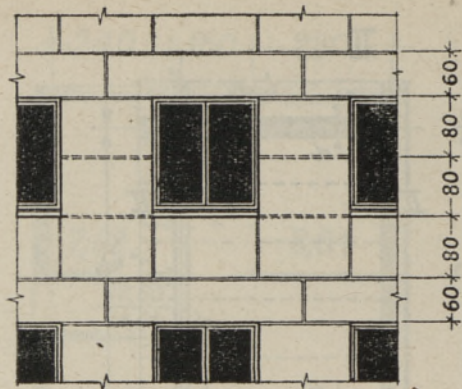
Четырехрядная разрезка наружных стен на основе двухрядной разрезки.
